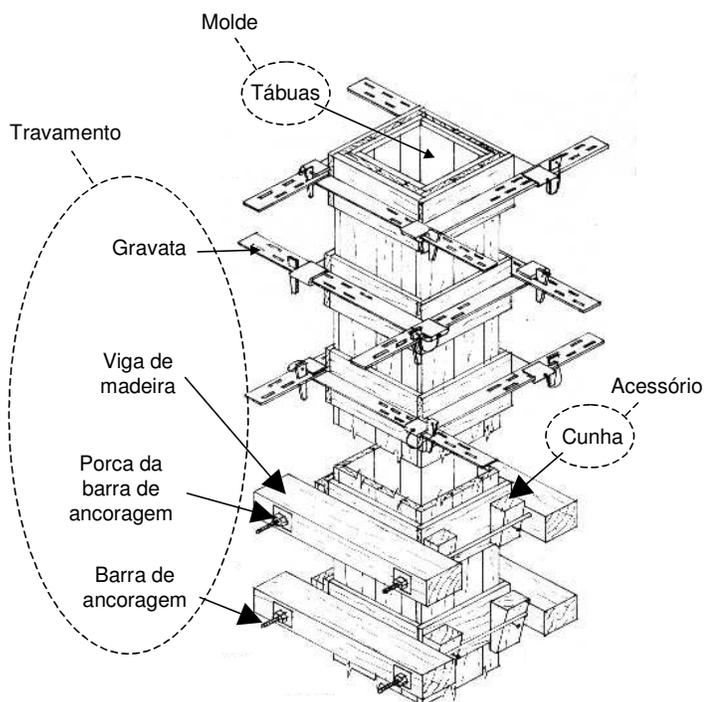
Esquema genérico de fôrma para pilar com molde em tábuas e travamento constituído por gravatas metálicas e vigas de travamento em madeira com barras de ancoragem (PETERS, 1991).
